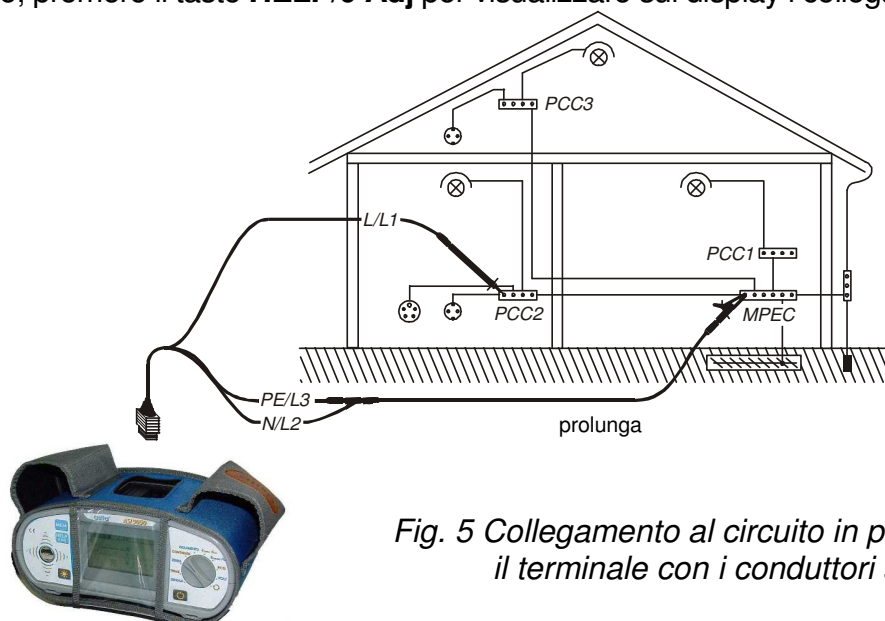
Collegamento al circuito in prova utilizzando il terminale con i conduttori separati.
